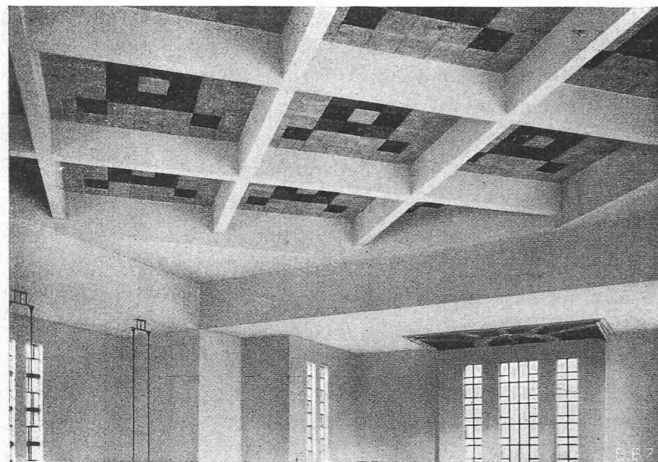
Plafond de l'église John Keeble à Mill Hill (Londres). Poutrason diagonale appuyée sur 4 côtés ; portée de 16,80 m avec dalles inférieures dans les angles.
